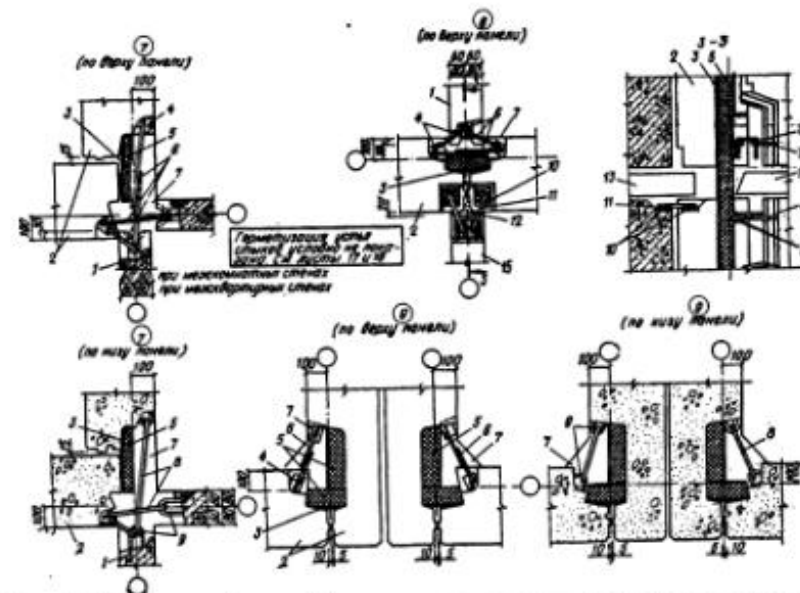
Узлы 7 - 9 сопряжений панелей наружных и внутренних стен: 1 - панель внутренней стены; 2 - наружная стеновая панель; 3 - воздухозащитная прокладка; 3 - утеплитель; 4 - стальная пластина; 5 - утепляющий вкладыш; 6 - соединительная полускоба; 7 - бетон замоноличивания; 8 - соединительная скоба; 9 - арматурные выпуски; 10 - закладная деталь; 11 - соединительный стержень; 12 - цементный раствор; 13 - плита лоджии; 14 - панель перекрытия; 15- поперечная стенка лоджии
